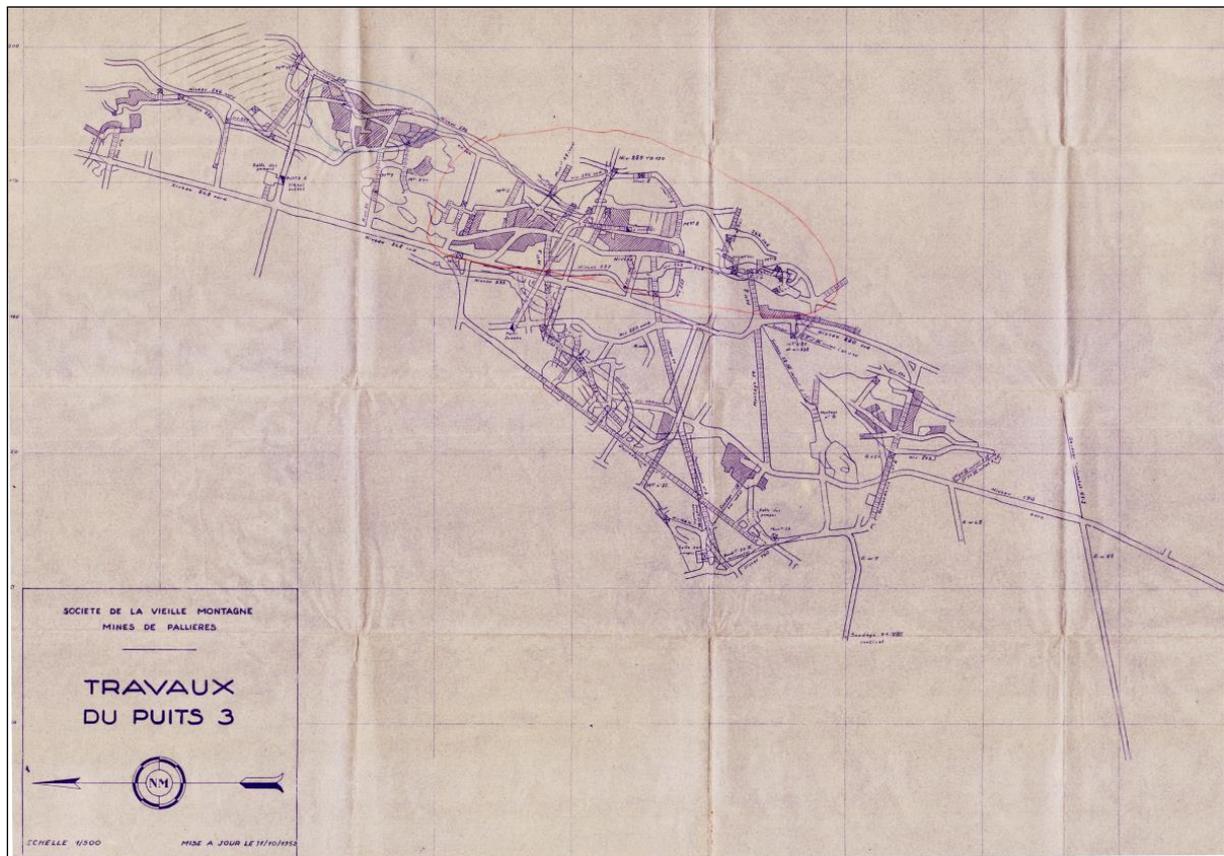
Croix de Pallières, travaux du puits n° 3 (1952)
